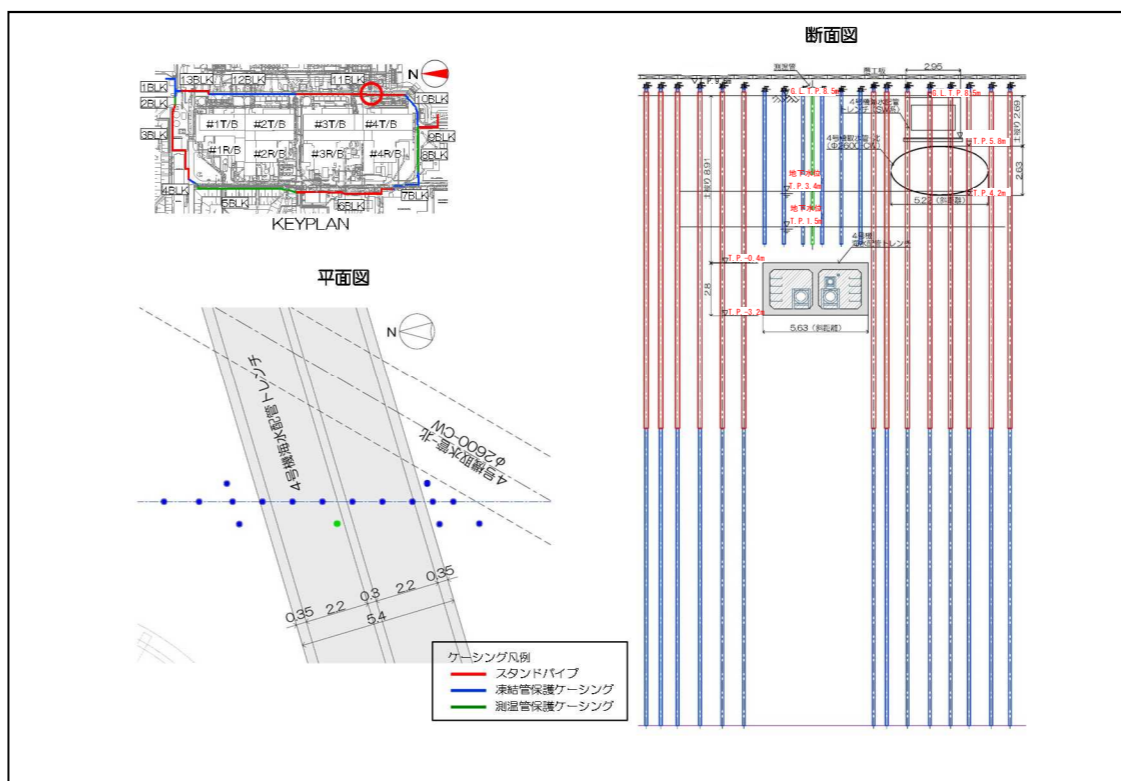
4号機海水配管トレンチ部 施工平面図・断面図
